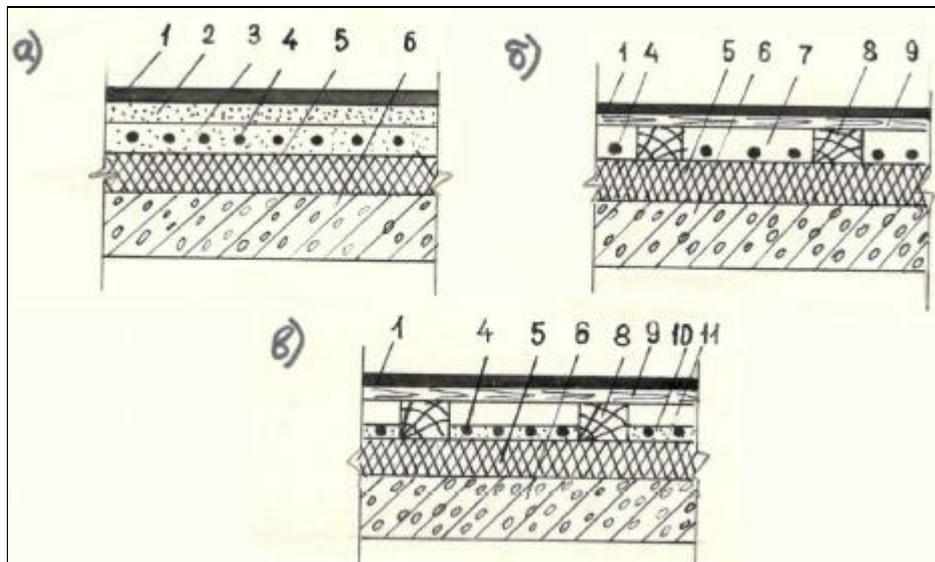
Греющий кабель в перекрытиях зданий: а – замоноличенный; б – в воздушной прослойке; в – замоноличенный под воздушной прослойкой; 1 – покрытие пола; 2 – стяжка толщиной 20 – 30 мм; 3 – монолитный слой толщиной 40 – 50 мм; 4 – греющий кабель; 5 – звуко-теплоизоляция; 6 – несущая железобетонная плита; 7 – воздушная прослойка толщиной 40 – 50 мм; 8 – лага 50x50 мм; 9 – настил пола; 10 – замоноличивающий слой 20 мм; 11 – воздушная прослойка толщиной 30 мм
